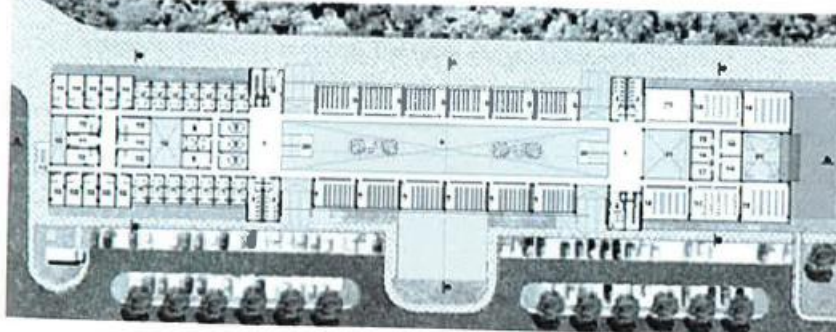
PLANTA TIPO (PAVIMENTOS 1 E 2) DO BLOCO ACADÊMICO
